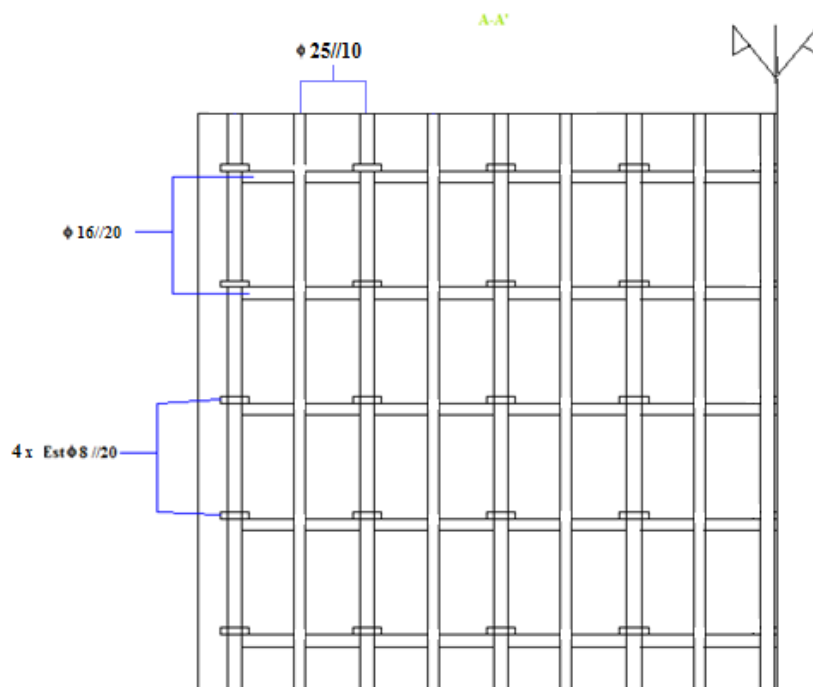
Corte A-A' da promenorização da parede moldada
